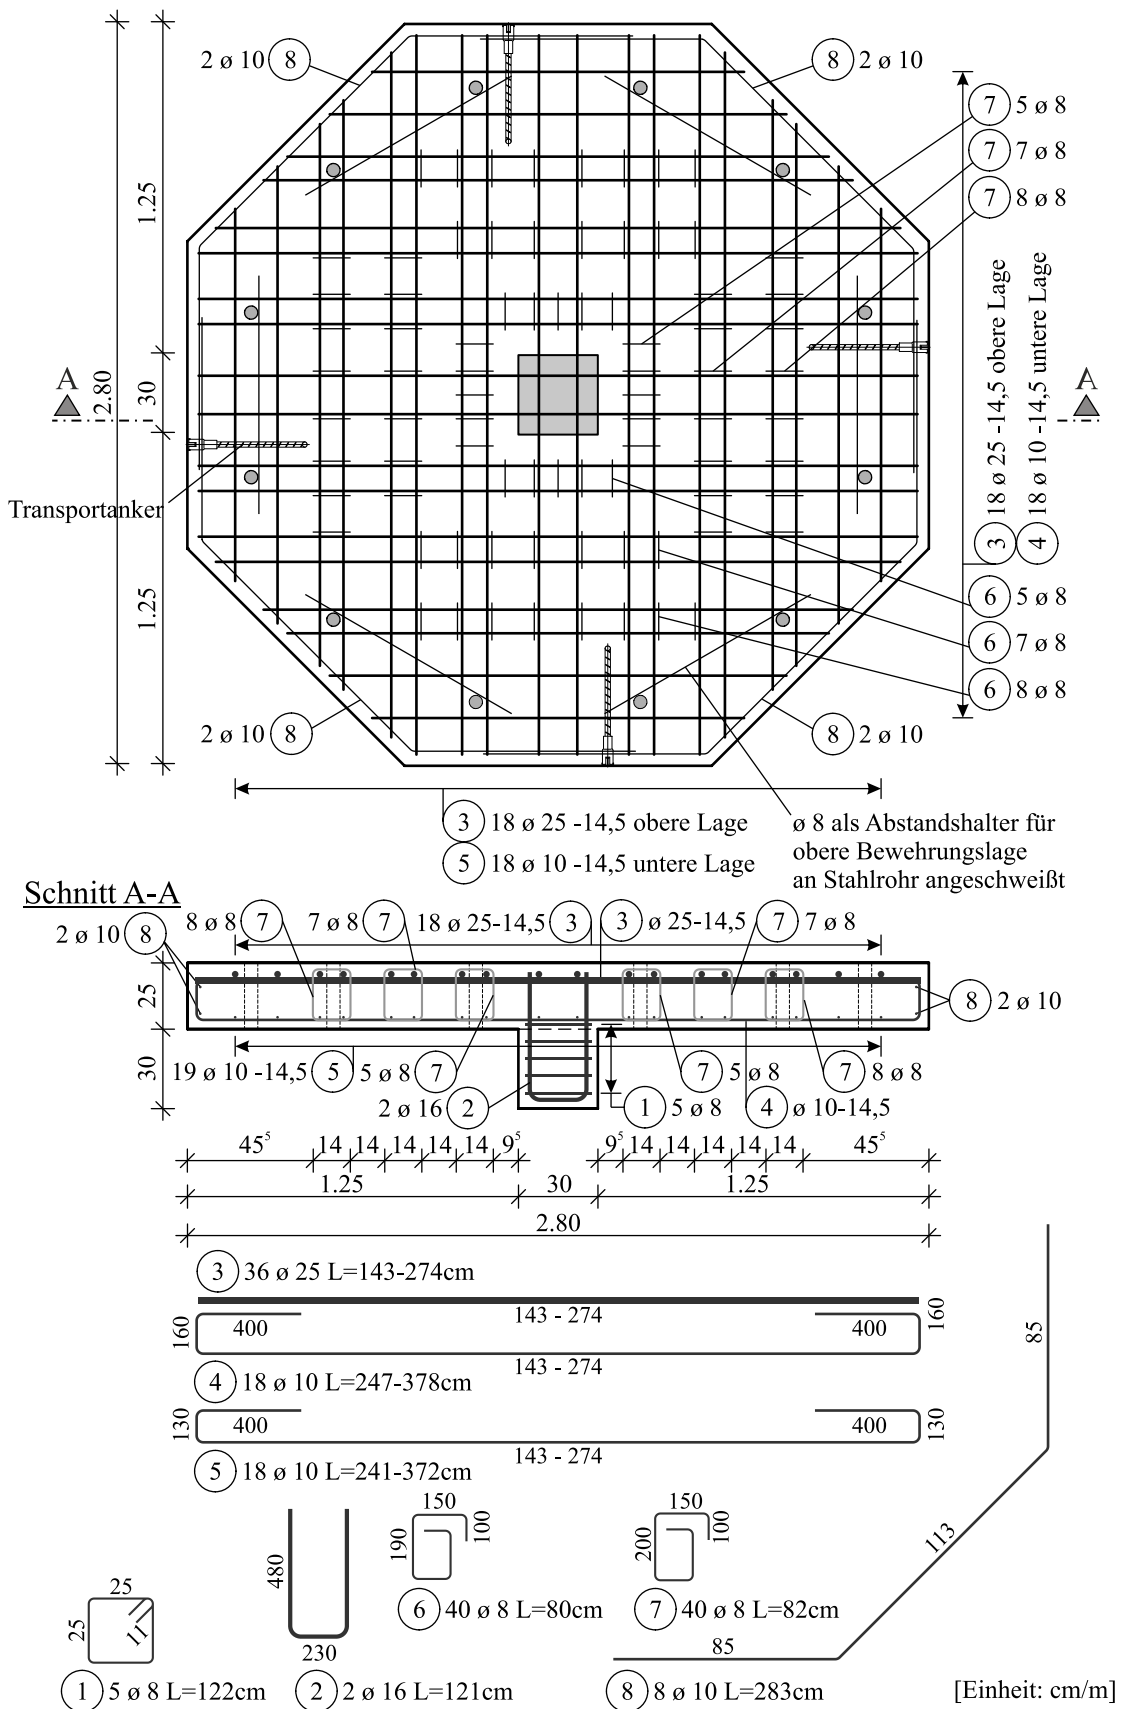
Bewehrungsplan des Versuchskörpers M3-25-1.75-B8
